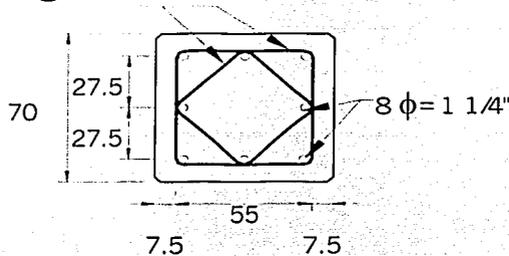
Croquis del Armado de Acero de Refuerzo en Pilotes
